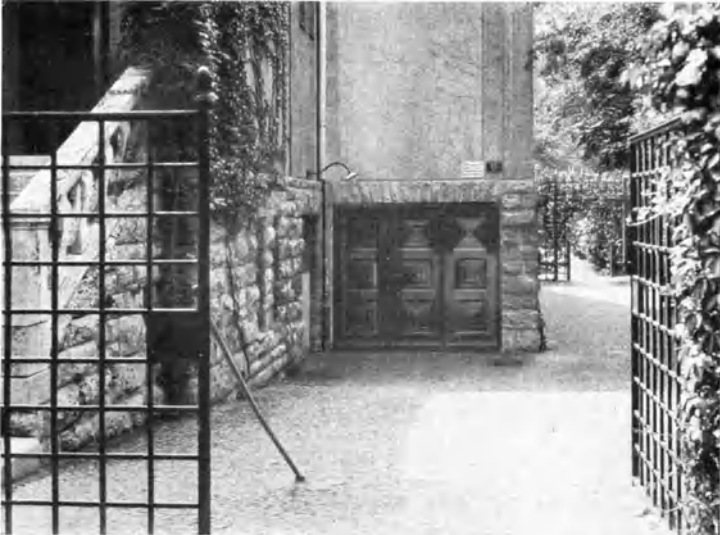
Eingebaute Einzelgarage mit abfallender Zufahrt.
